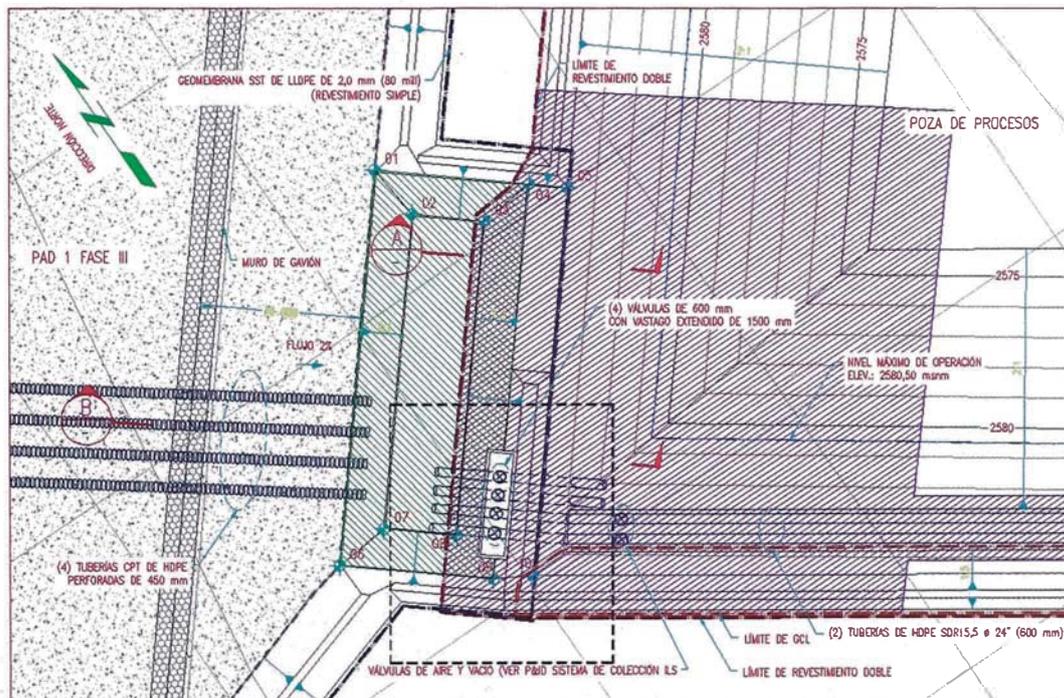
Poza de colección de la solución (Vista en Planta).
